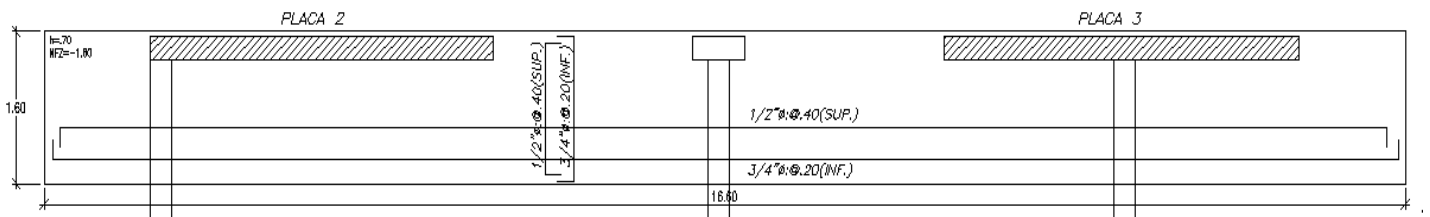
Armado de la zapata ubicada entre los ejes 9 y E
